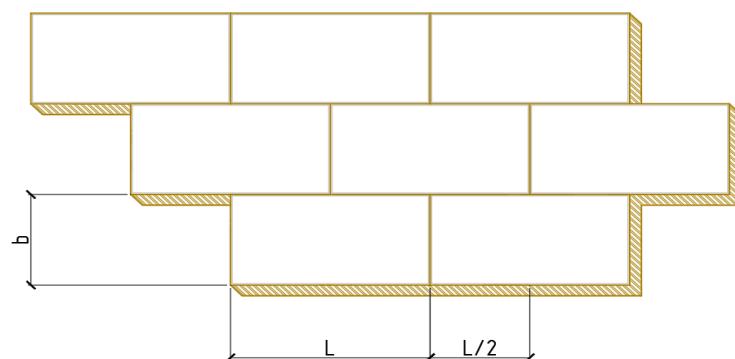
Смещение плит нижнего слоя теплоизоляции при укладке
